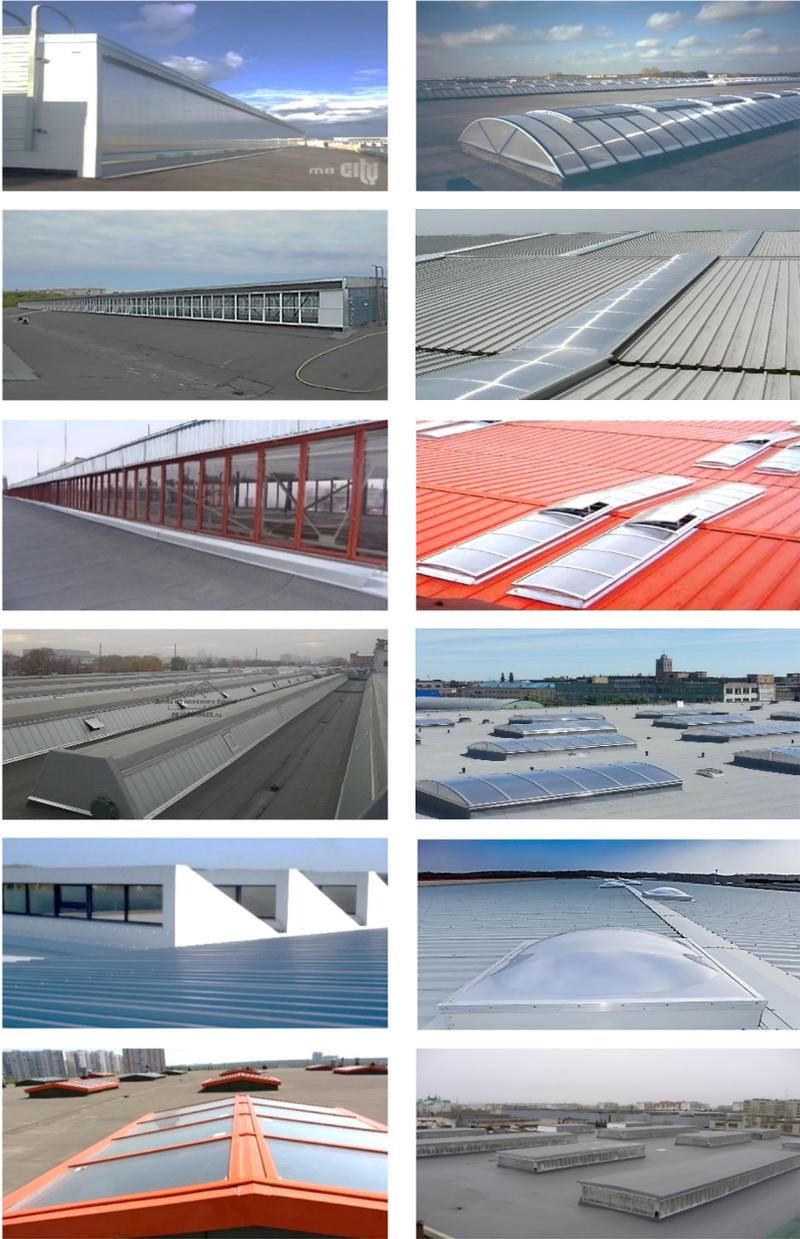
Примеры фонарей на покрытиях промышленных зданий
